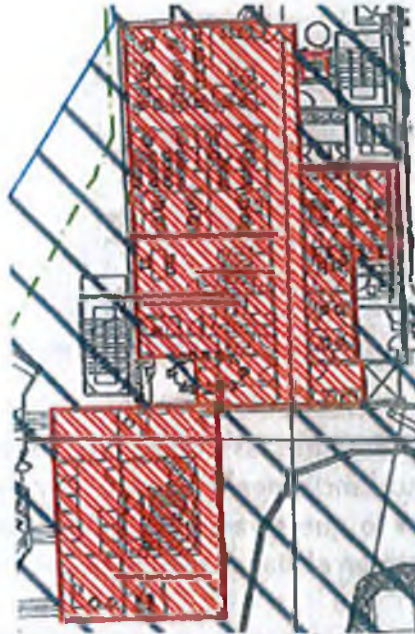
Planta primer pisos áreas de la Aerocivil
